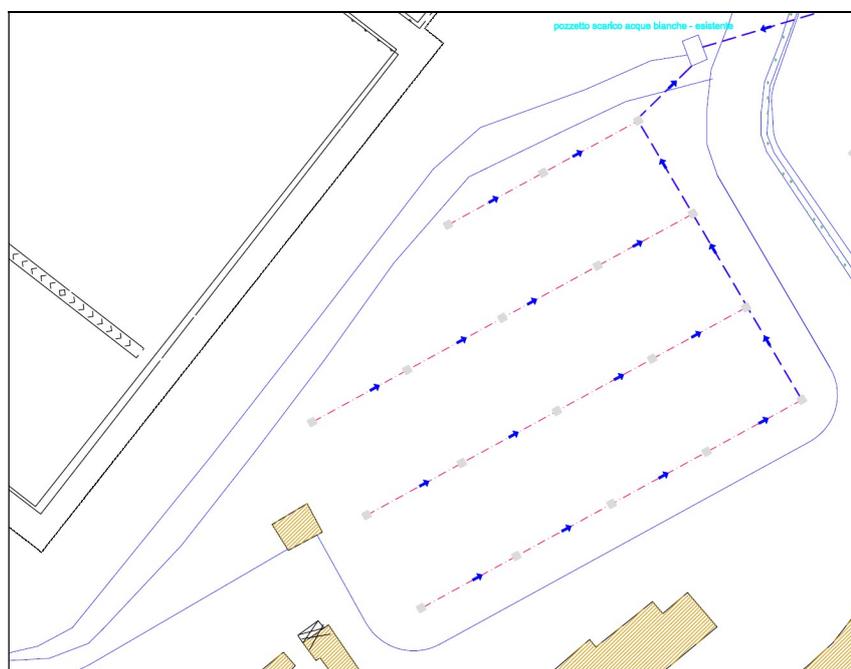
Planimetria dell'area barche con la rappresentazione delle opere in progetto
